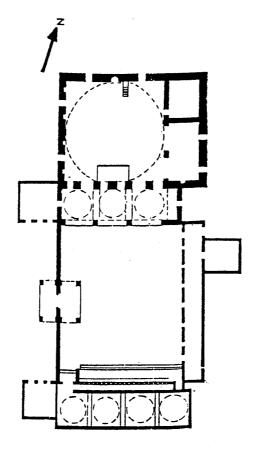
مسقط أفقي للجامع الكبير بصنعاء اليمن (عن : كريزول) .
